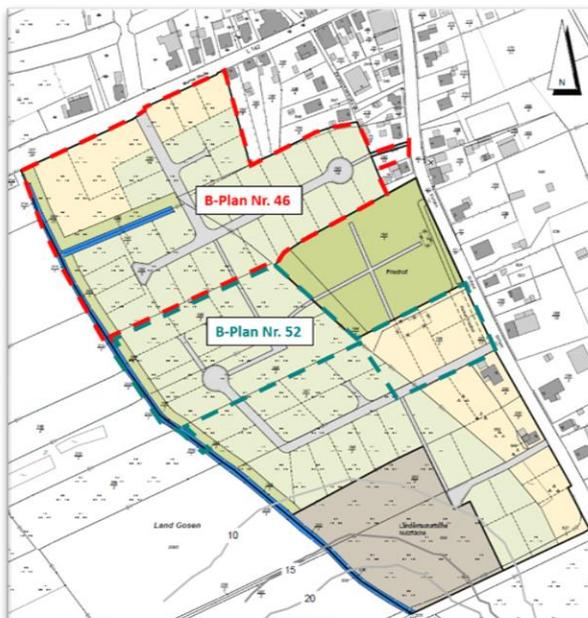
Erschließungsvariante mit Wendeanlage für das F - Plangebiet (Planungsbüro Philipp 2021)
